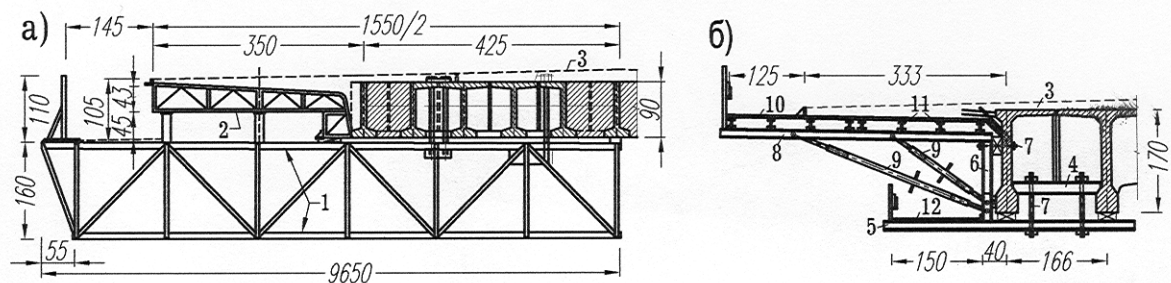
Схеми підвісної опалубки ГНДЛ-88 (а) і фірми DoKa (б), для бетонування консолей накладної плити 1 – підвісні металеві ферми; 2 – блоки опалубки; 3 – контур накладної плити; 4 – опорні поперечини; 5,8 – нижній і верхній ригелі; 6 – стійка; 7 – стяжні болти; 9 – шпindelьні розкоси; 10 – дерево-фанерні плити; 11 – балки Н20Р; 12 – нижній робочий настил
